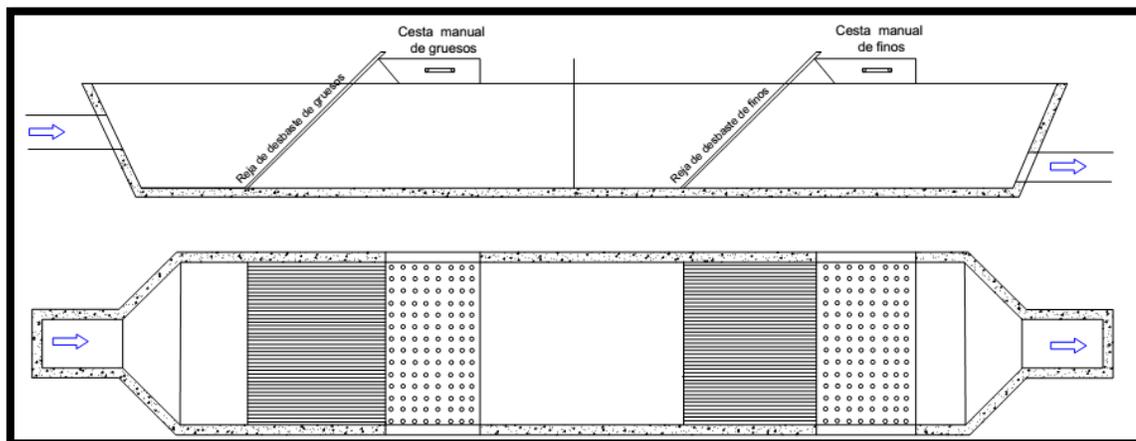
, Vista de planta canal de desbaste compuesto por reja de finos y rejas de gruesos
